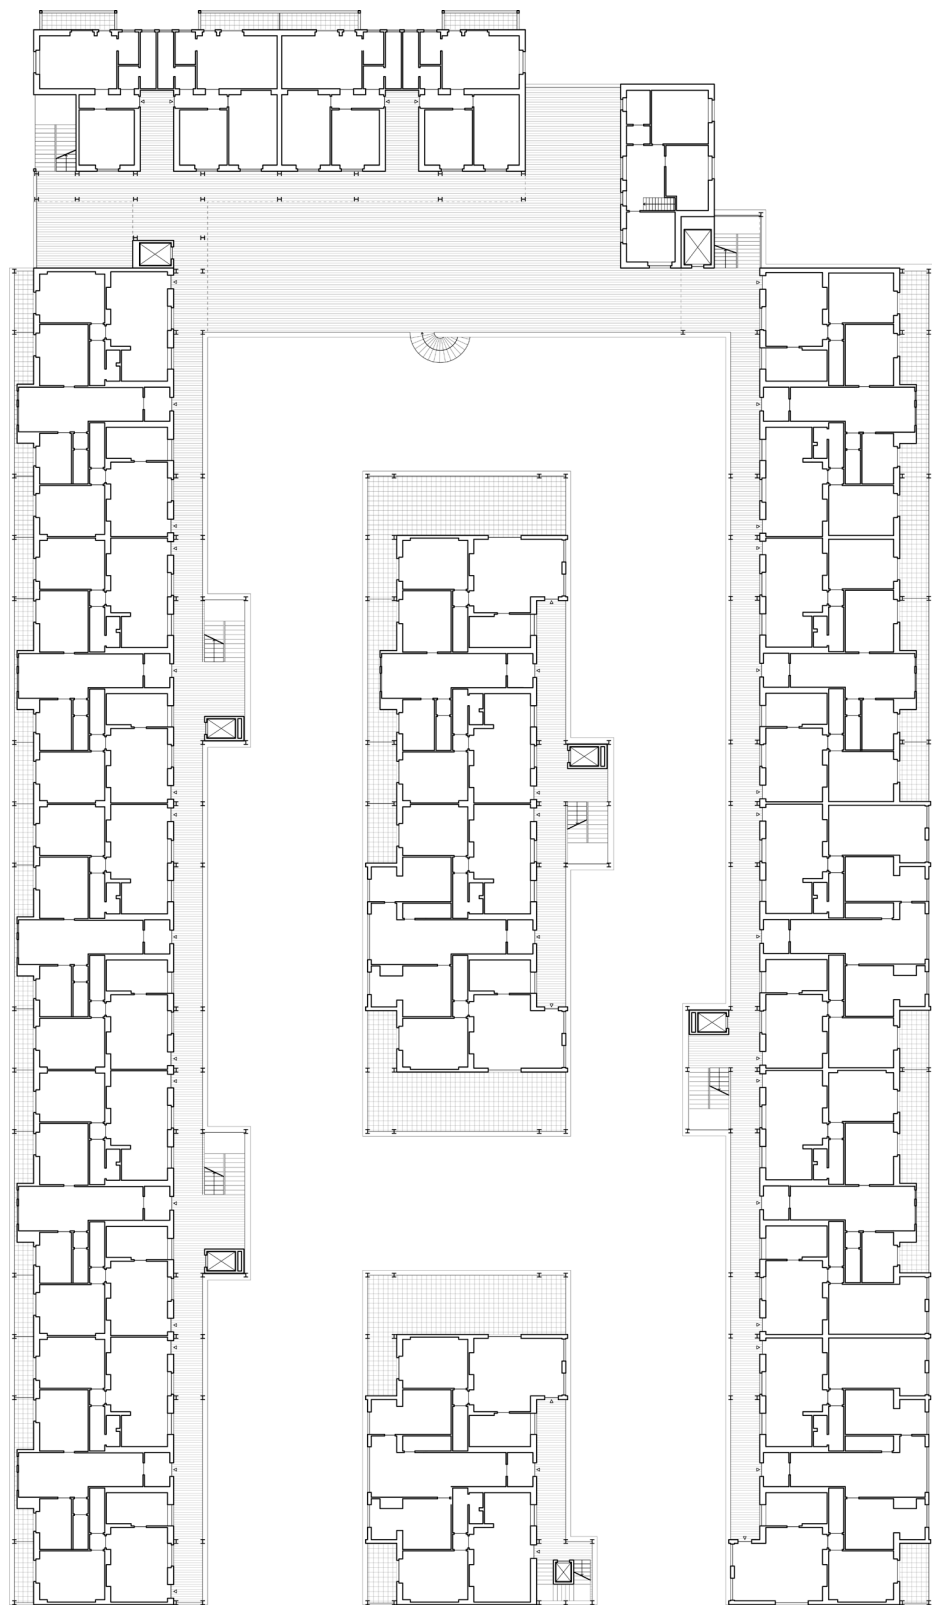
Pianta progettuale piano primo dei ballatoi. Elaborazione degli autori.
